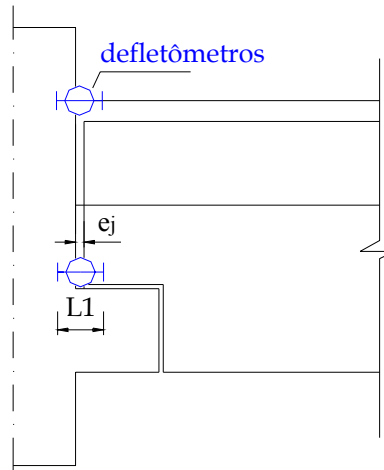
Ligação pré-moldada: instrumentação para o cálculo da rotação.
